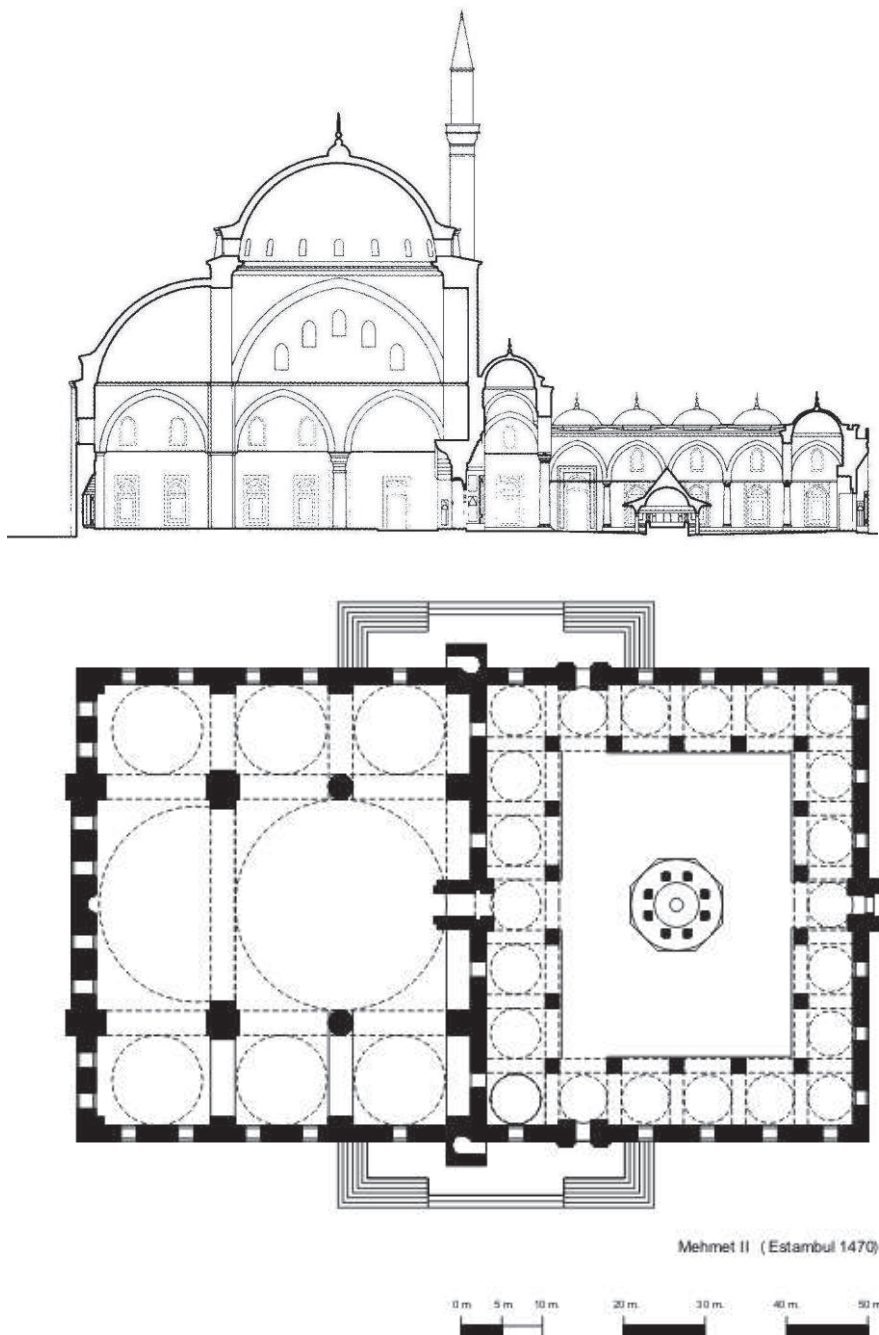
Fatih Mehmet Camii. Planta (original) y sección longitudinal. (Dibujo del autor)
